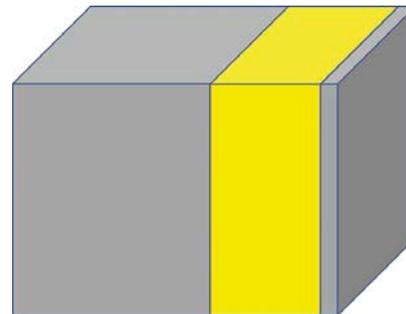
Blendrahmen vertikal mit Position der Befestigungsmittel
